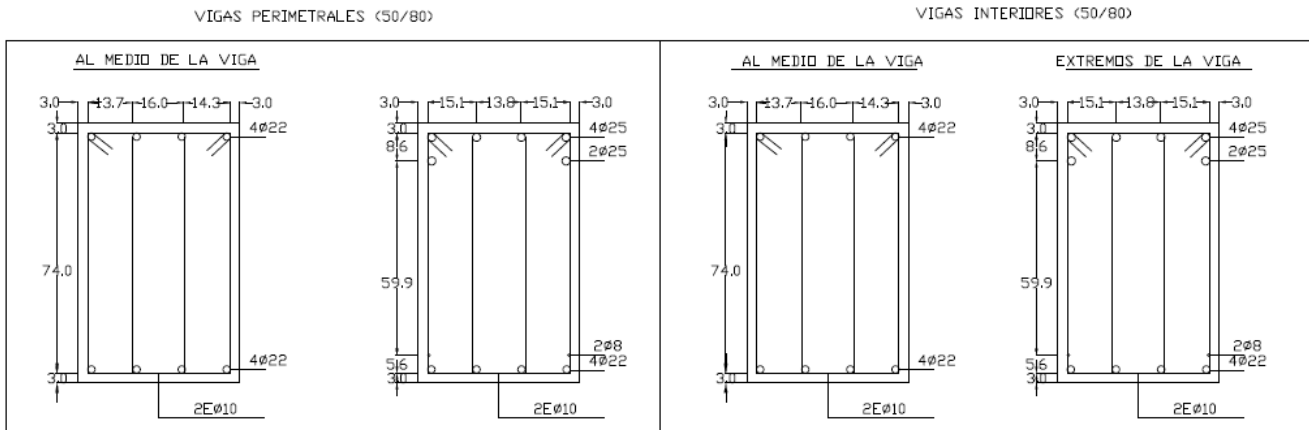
Sección transversal de las vigas del piso 1 del caso de estudio 2
